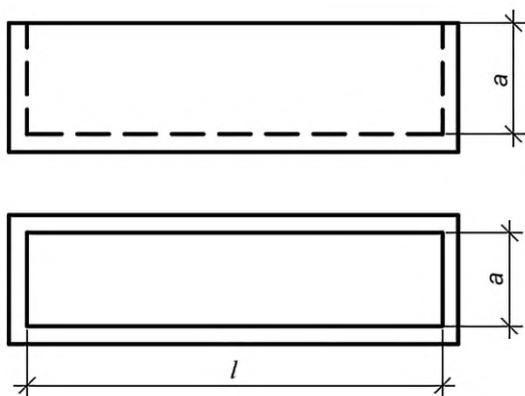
Формы для изготовления образцов в виде призмы (балочки). Тип ФП
